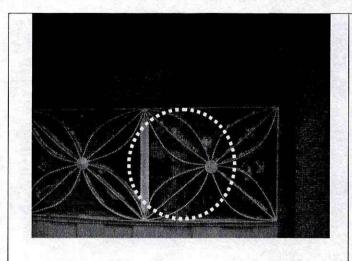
Se observa el material de relleno depositado sobre el corredor de acceso de la vivienda ubicada en la Calle 50C Sur No. 5-15.
